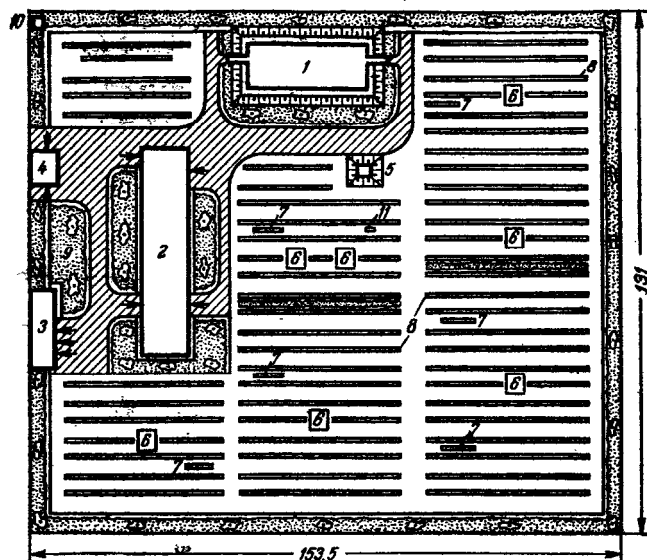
Пчеловодческая ферма на 2400 пчелиных семей (общий план):
